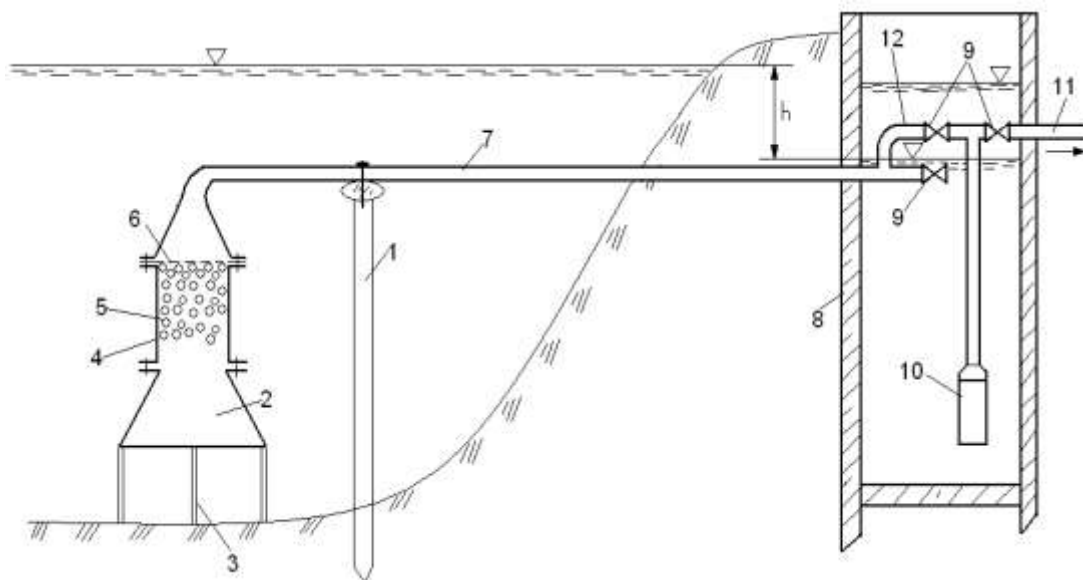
Схема роботи руслового водозабору з трубним фільтрувальним оголовком: 1 – пальова опора; 2 – розтруб; 3 – стояки; 4 – кожух; 5 – плавуче фільтрувальне завантаження; 6 – сітка; 7 – самопливний трубопровід; 8 – береговий колодезь; 9 – засувки; 10 – заглибний насос; 11 – напірний трубопровід; 12 – промивний трубопровід
